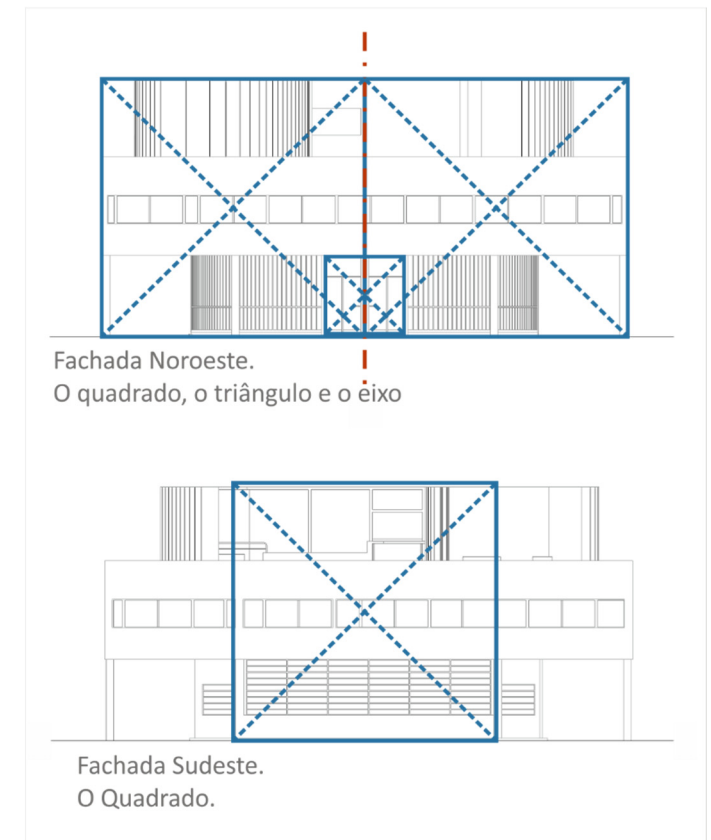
Vila Savoye, diagrama dos traçados reguladores nas fachadas noroeste e sudeste. Fonte: Autora, 2017.
